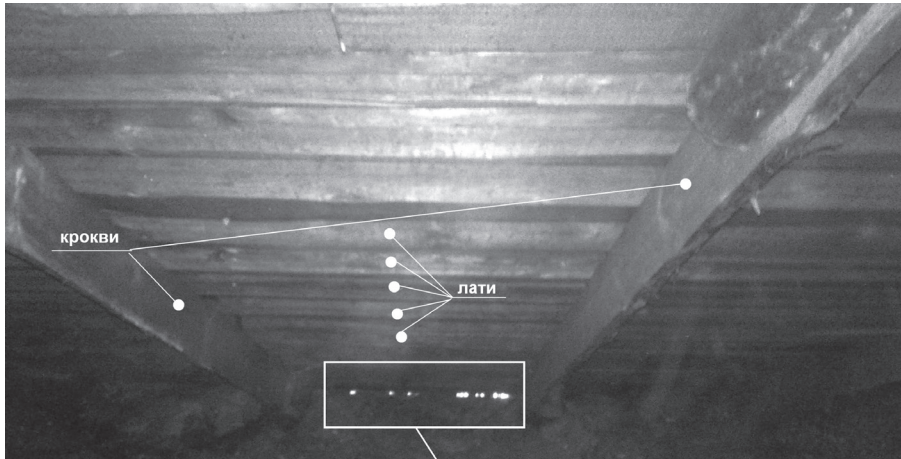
Спирання скатної конструкції даху на зовнішню стіну будівлі
